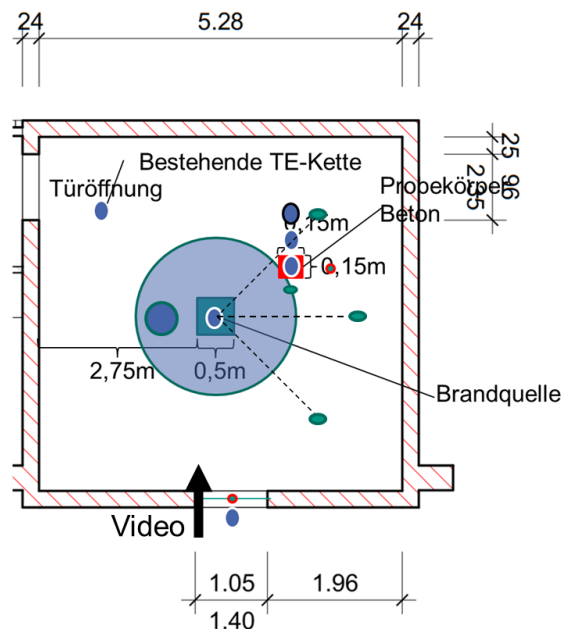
Versuchsaufbau Brandraum Grundriss
